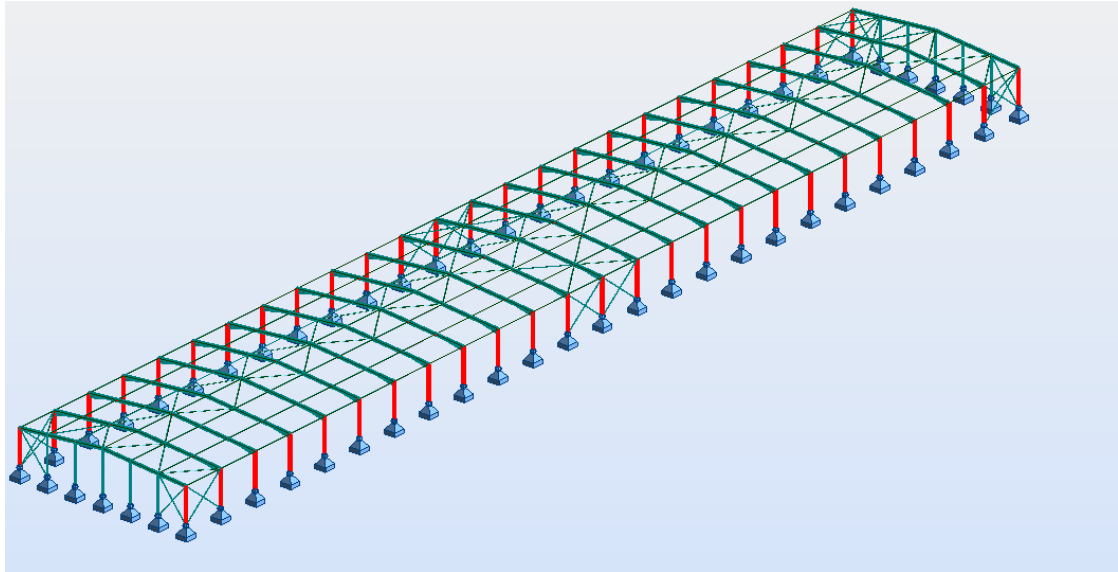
Pilares laterais em HEA 400 da estrutura
